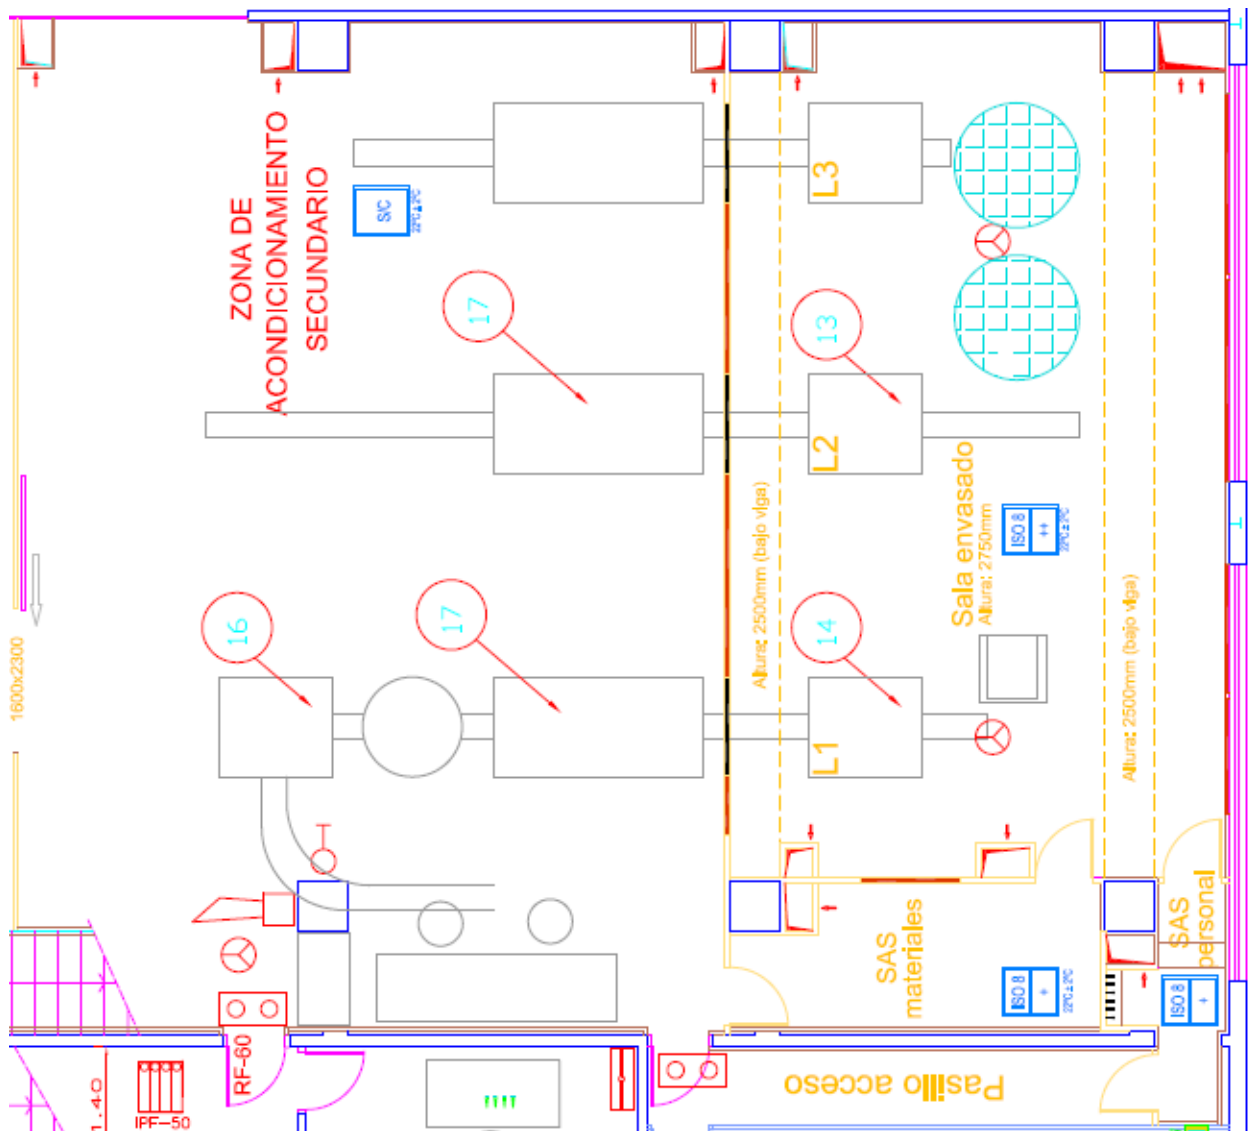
Layout Zona Envasado (Planta Baja)
